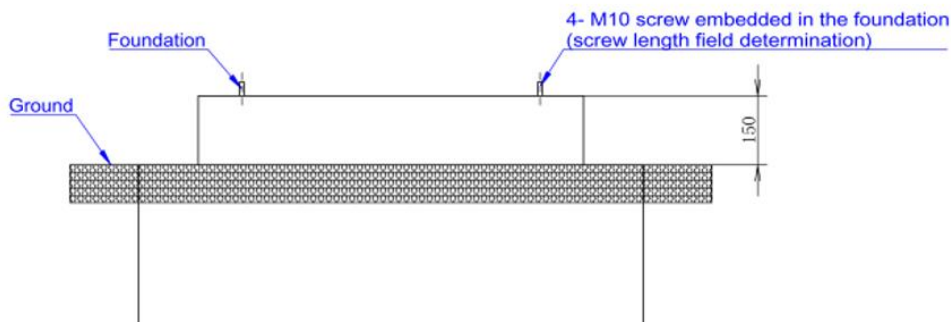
Orientações para construção da base de alvenaria para fixação do carregador Nansen DC
